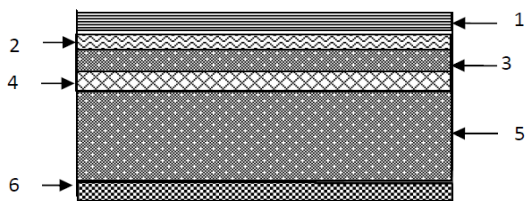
Coupe transversale dans le plancher terrasse inaccessible.
